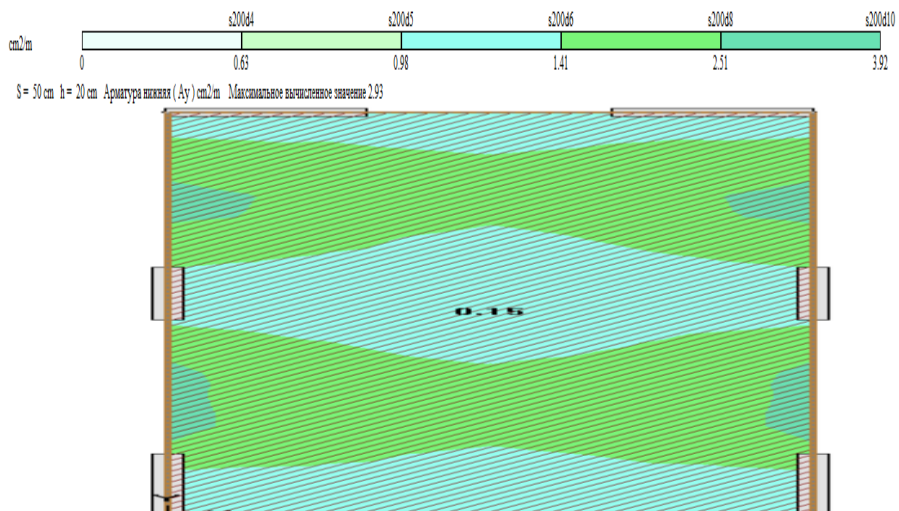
Схема ізопалей та ізоліній арматури нижніх сіток плити вздовж осі Y
